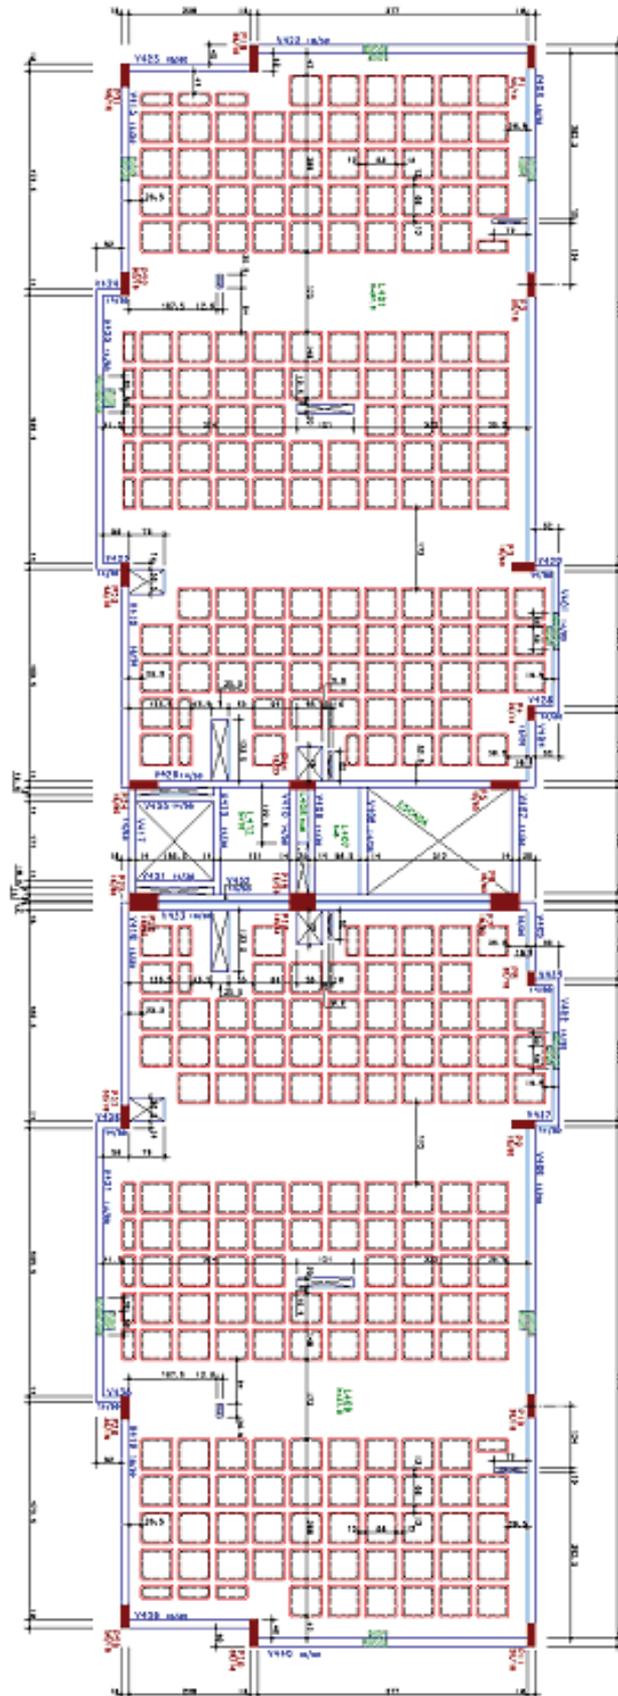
planta de fôrmas completa do pavimento tipo em laje nervurada com cubetas de polipropileno
